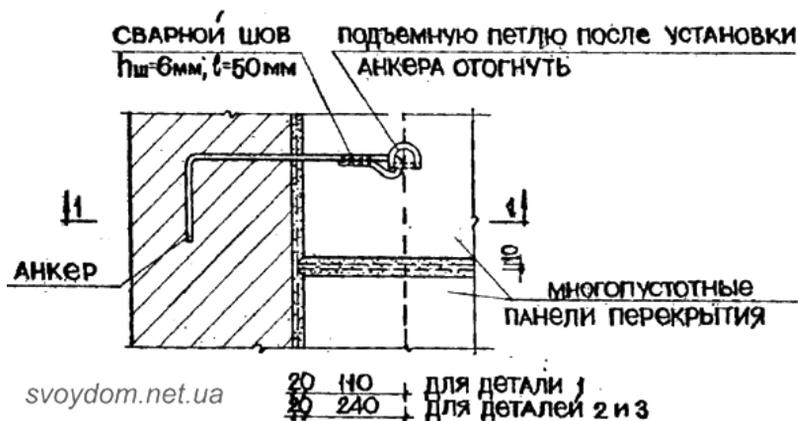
Детализовка рисунка 3.1.1. узел – Б : правильная анкерка сборной ж/б плиты перекрытия к кирпичной стене.
